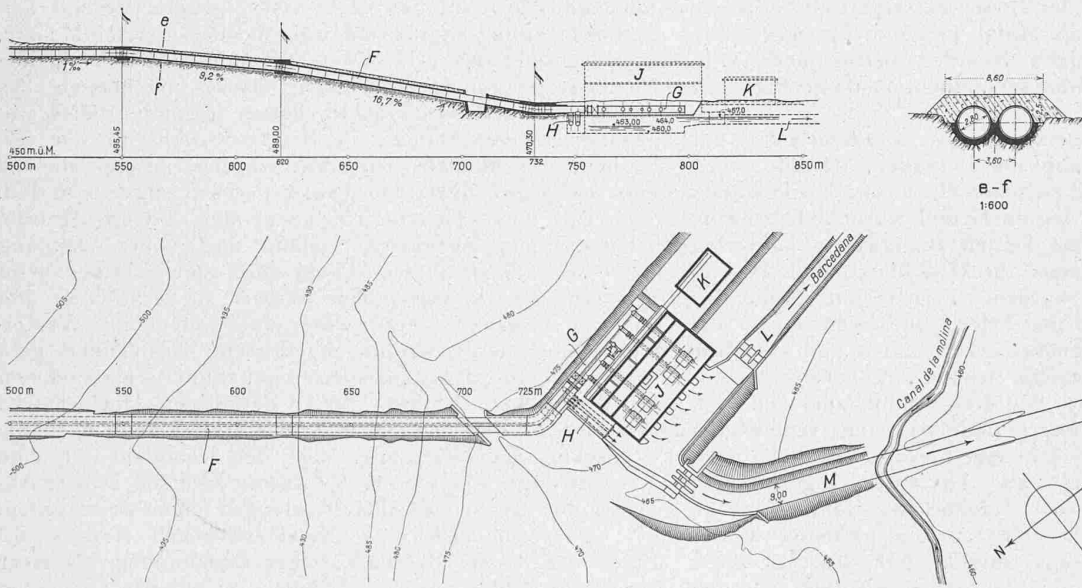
Lageplan und Längsschnitt, unterer Teil. — 1:3000. (Legende siehe bei Abb. 3 nebenan.)
